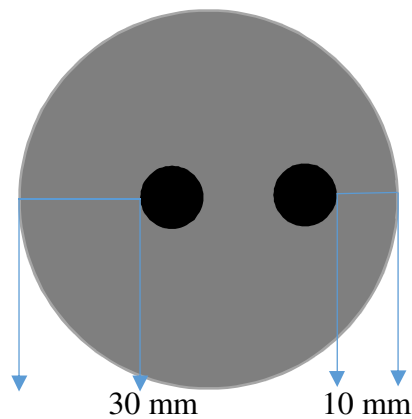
Disposición de las barras en la cara del cono truncado de menor diámetro.
